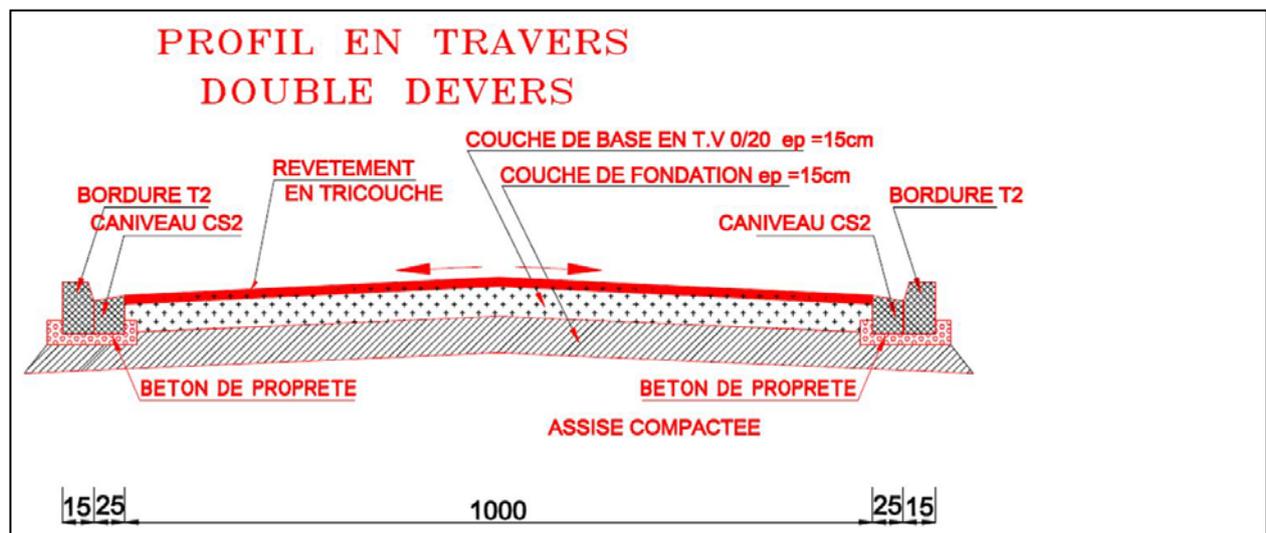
Coupe type du corps de chaussée type voie en enrobé avec doubles dévers
